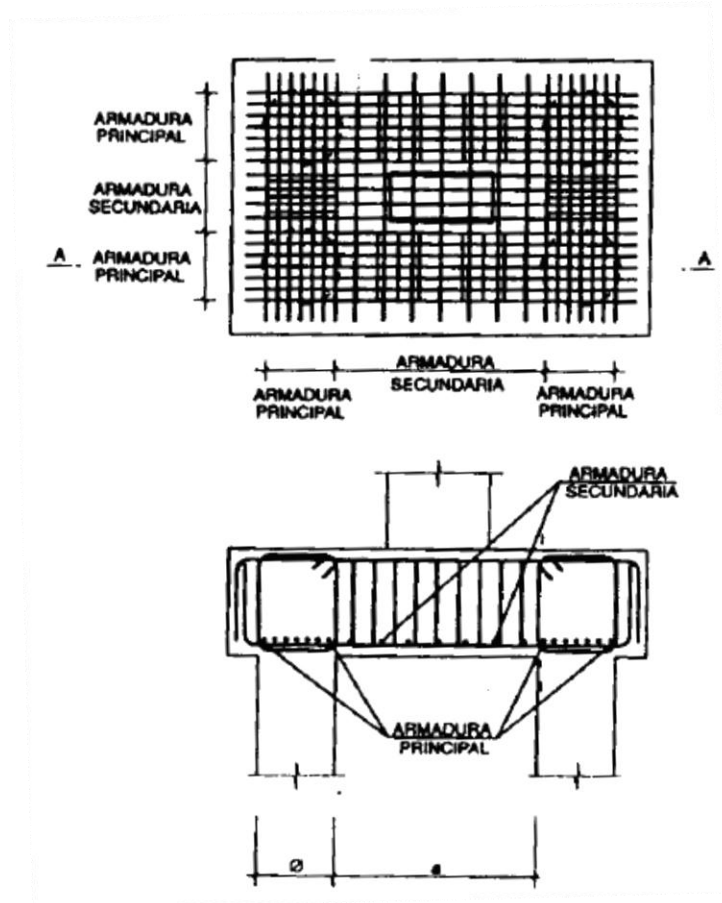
Disposición de armaduras en encepados rígidos sobre varios pilotes³⁵
